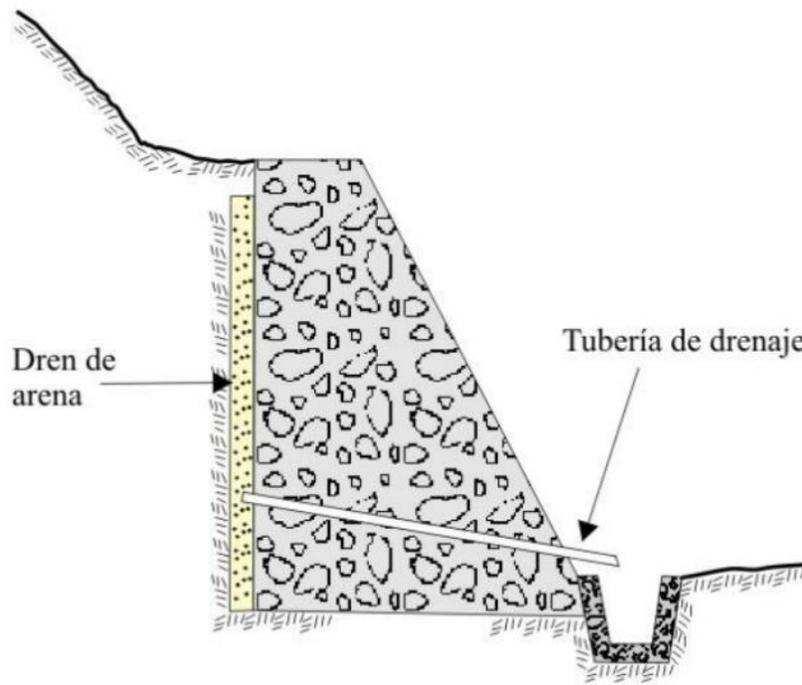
Muros de gravedad de concreto ciclópeo. Tomado de Ingemmet (2000).
